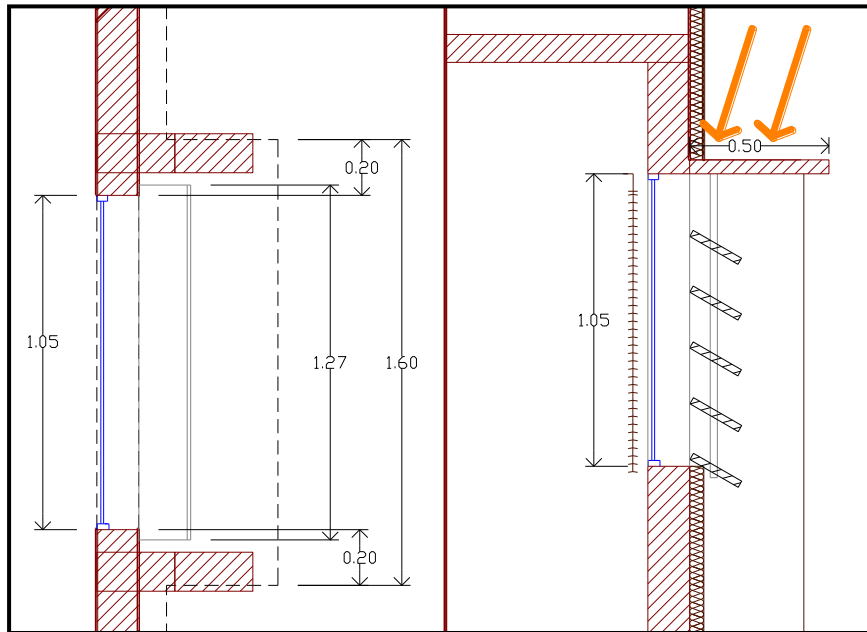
Planta y corte de propuesta hacia el poniente.
